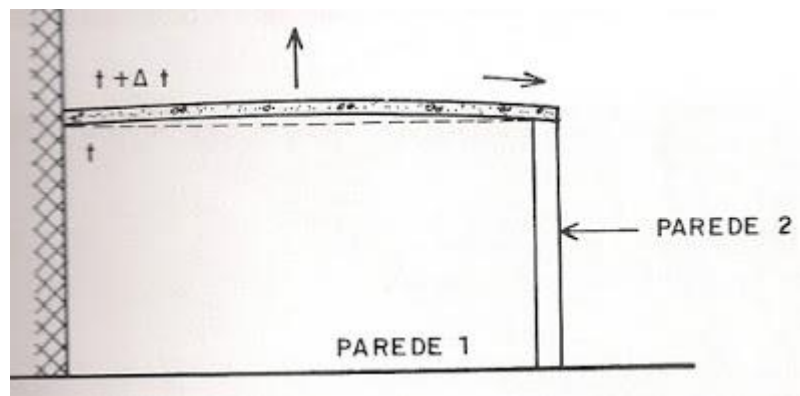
Abaulamento da laje causado por dilatação térmica.
